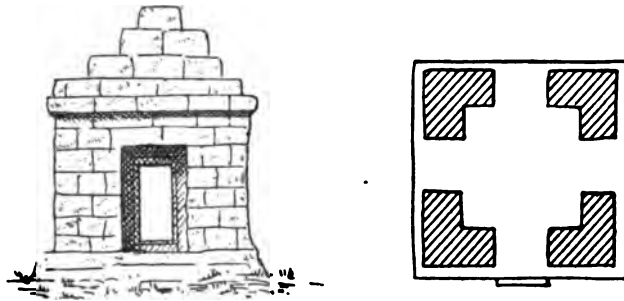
Kuk Ta Prohm, n° 89. Plan et croquis.
